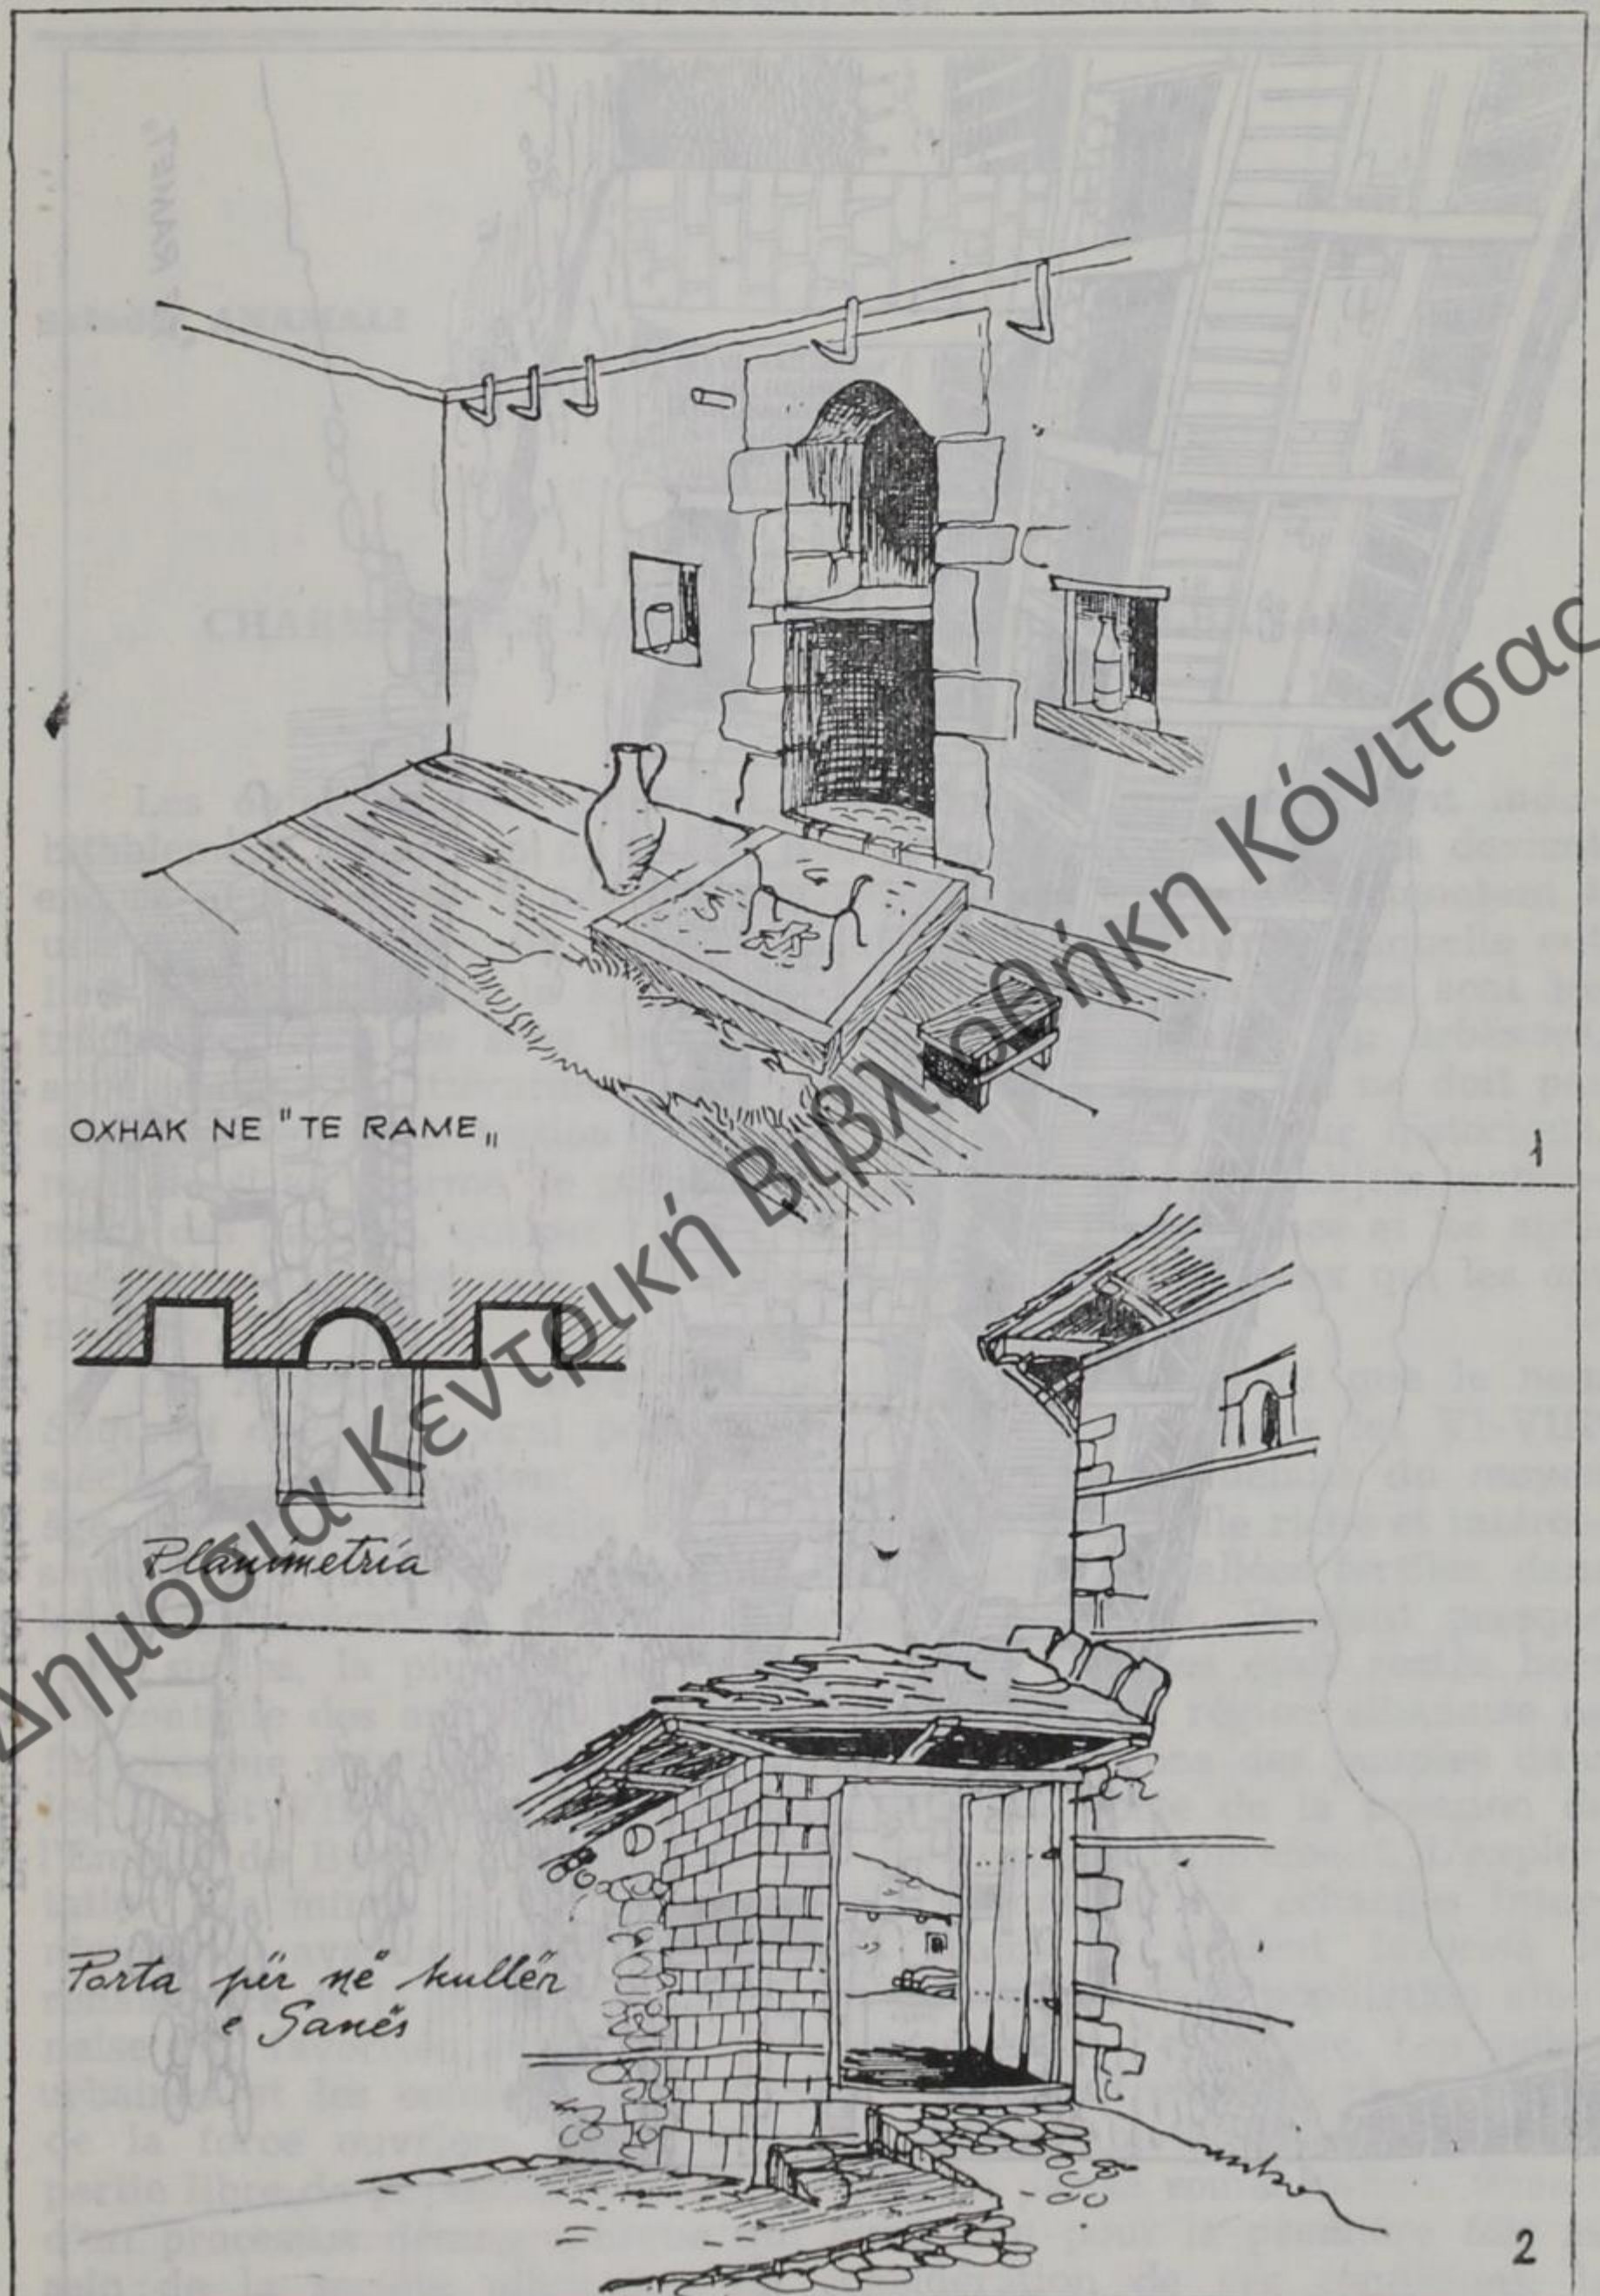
Planche IV. Cheminée dans les gîtes. Planimétrie. La porte donnant accès au Fénil ou Grenier à foin.
